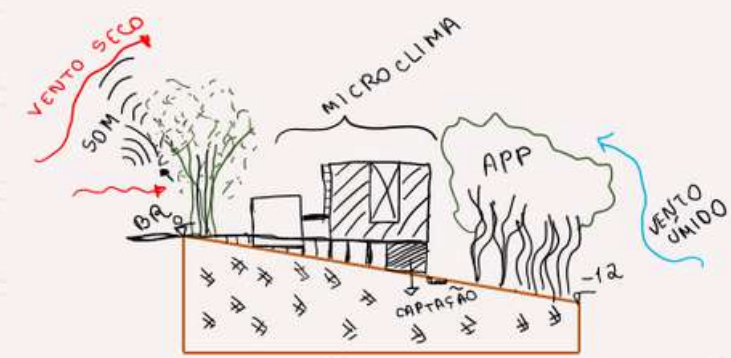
Croqui - teste. Corte transversal preliminar esquemático supondo conexões por níveis sentido. Produção da autora. Sem escala
